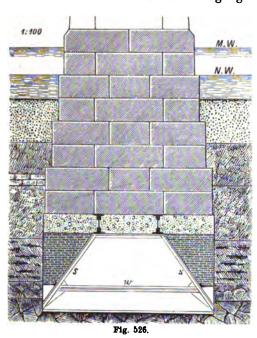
zeigt den Caisson des Pfeilers bei Kaufring im Grundriss und Fig. 526 im Verticalschnitt. Die 470 mm hohen Hauptquerträger in 2,3 m Abstand, über die ganze Breite der Decke reichend, tragen 2 Reihen 420 mm hoher Längsträger, zwischen welche nochmals Nebenquerträger eingesetzt sind, um für das Steinlager und die Decke kleine Felder zu Das Deckblech hat während des erhalten. Senkens nur einen Theil der zwischen den Deckenträgern eingebrachten Betonausfüllung
